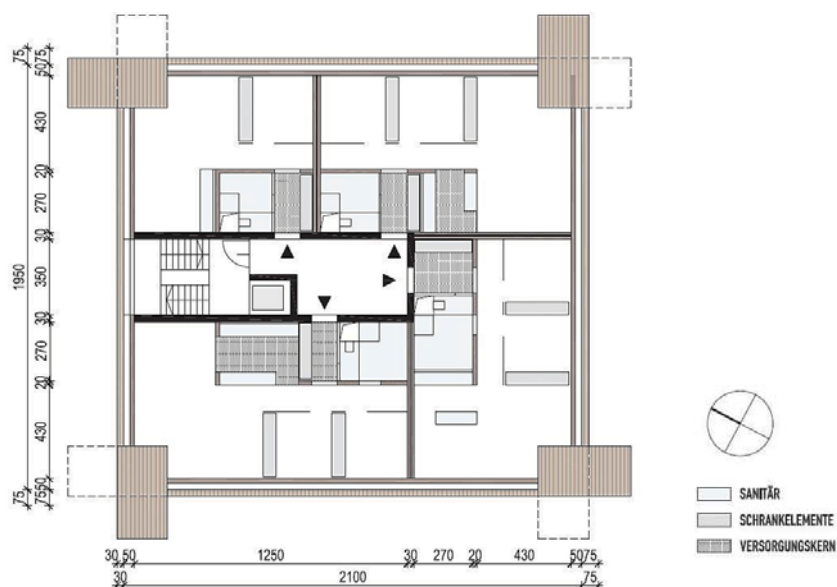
Grundrisstyp Prunkhaus 2<sup>290</sup>
